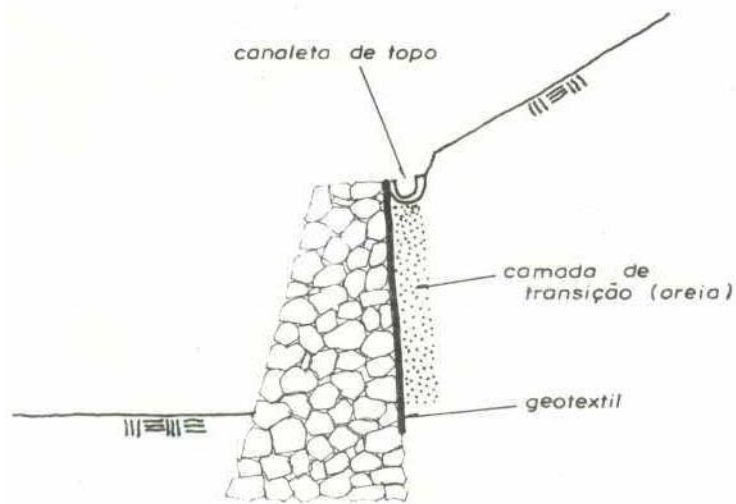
Muro de pedra seca (CUNHA, 1991)
